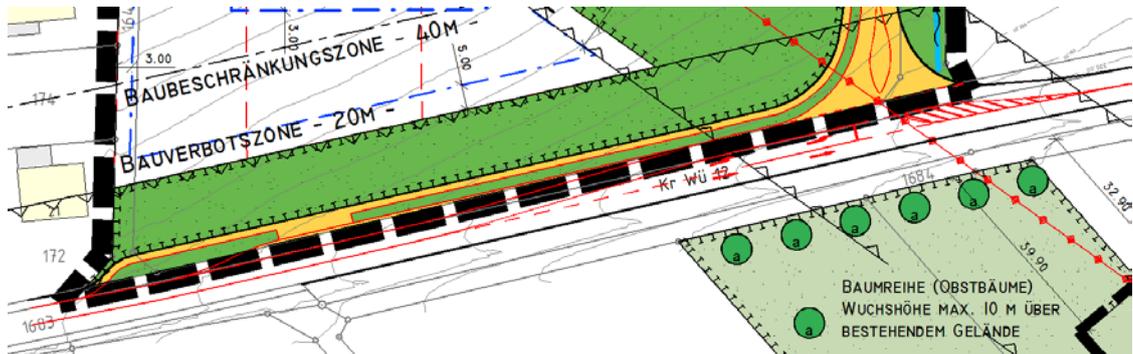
Planausschnitt „Zufahrt Kr Wü 12“
